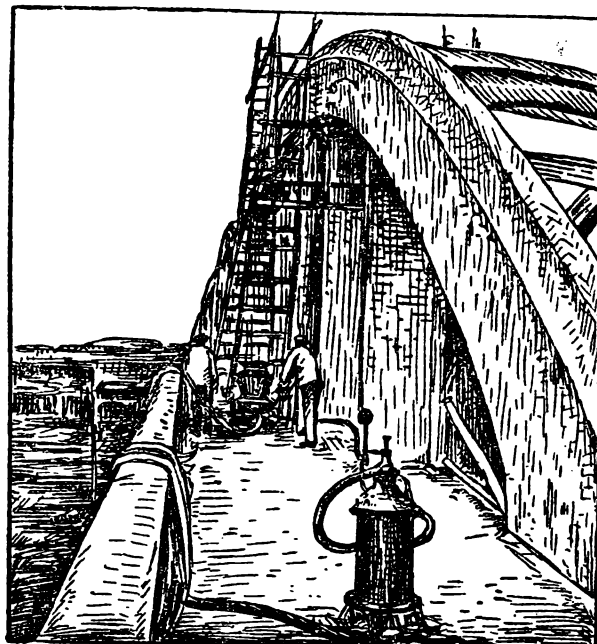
Ремонт железобетонного моста пневматическим бетоном.
